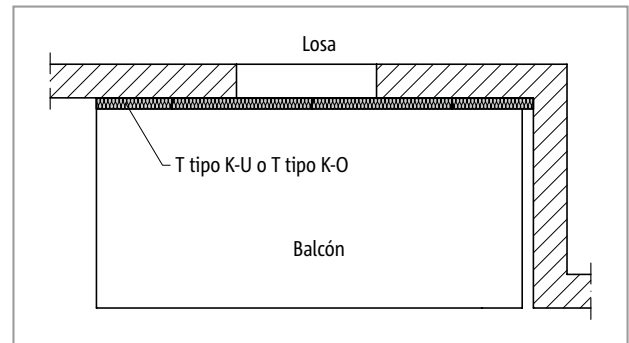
Schöck Isokorb® T tipo K-U o T tipo K-O: Balcón en fachada saliente
